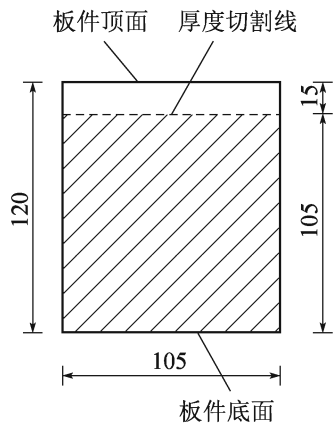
厚度切割线位置示意图 (尺寸单位: mm)
